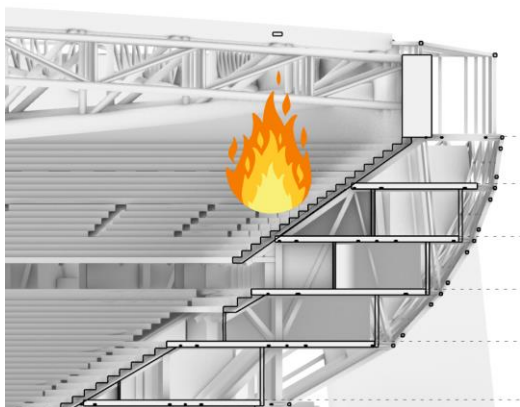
Overzicht brandwerendheid hoofddraagconstructie
